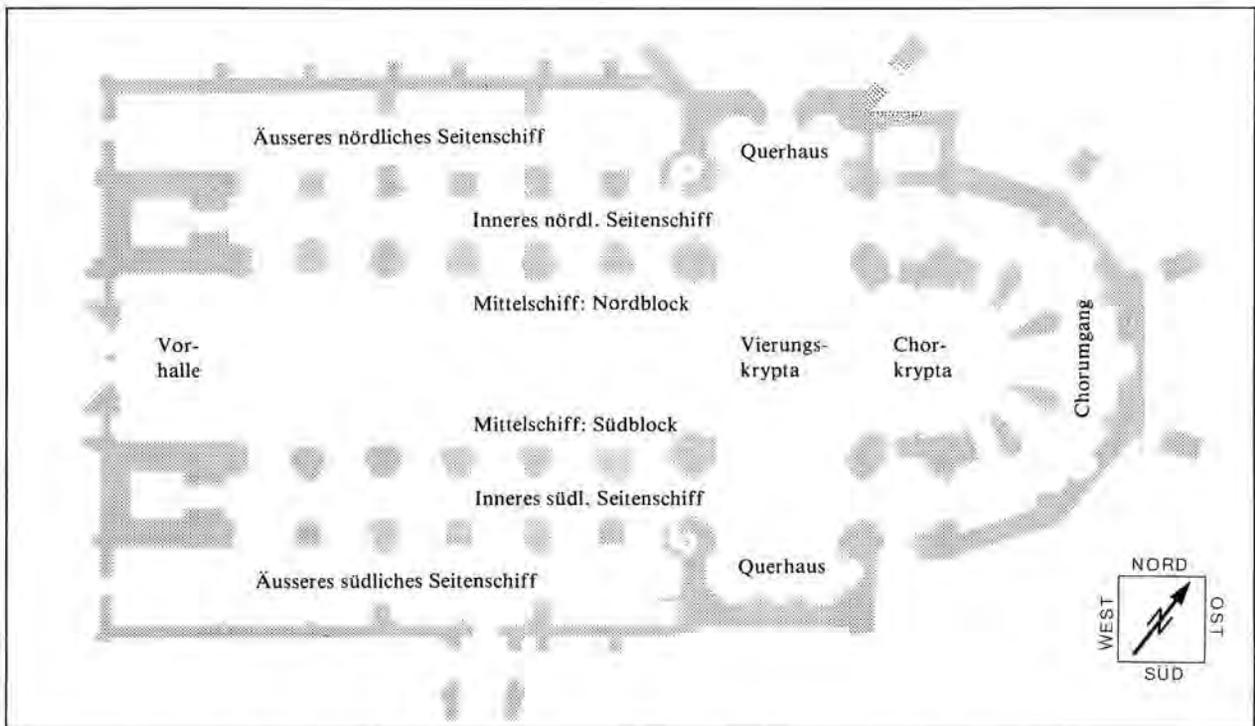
Grundriss des Basler Münsters mit den im Text verwendeten Bezeichnungen (1:500).
